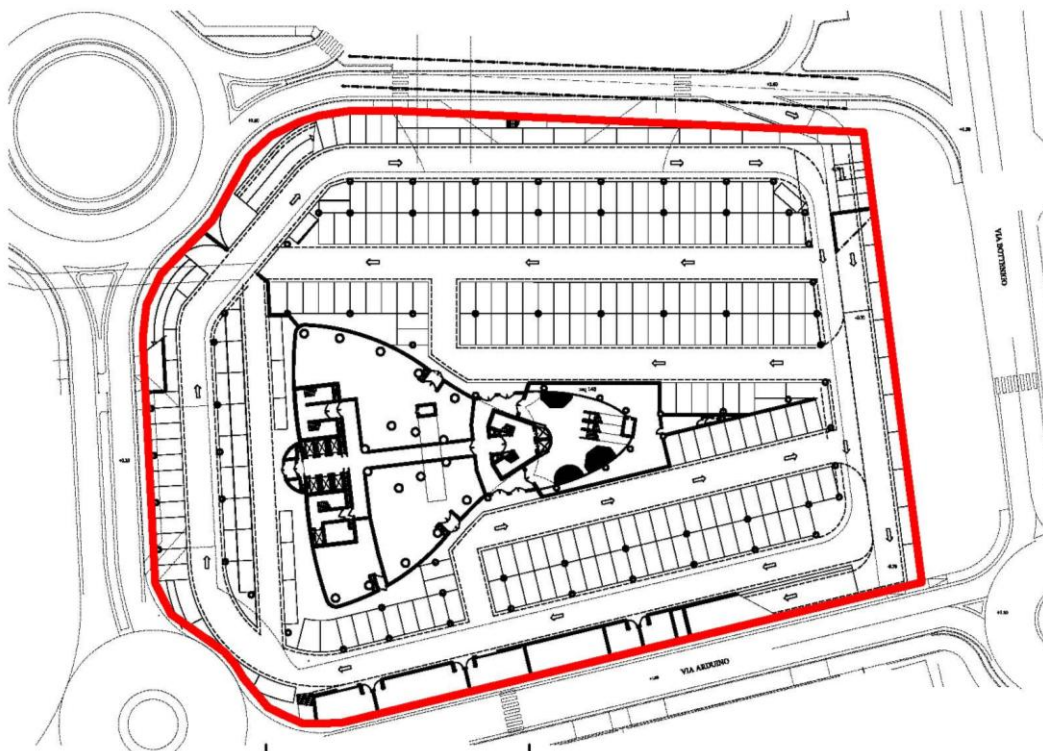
planimetria del parcheggio interrato con l'individuazione dell'area di scavo
